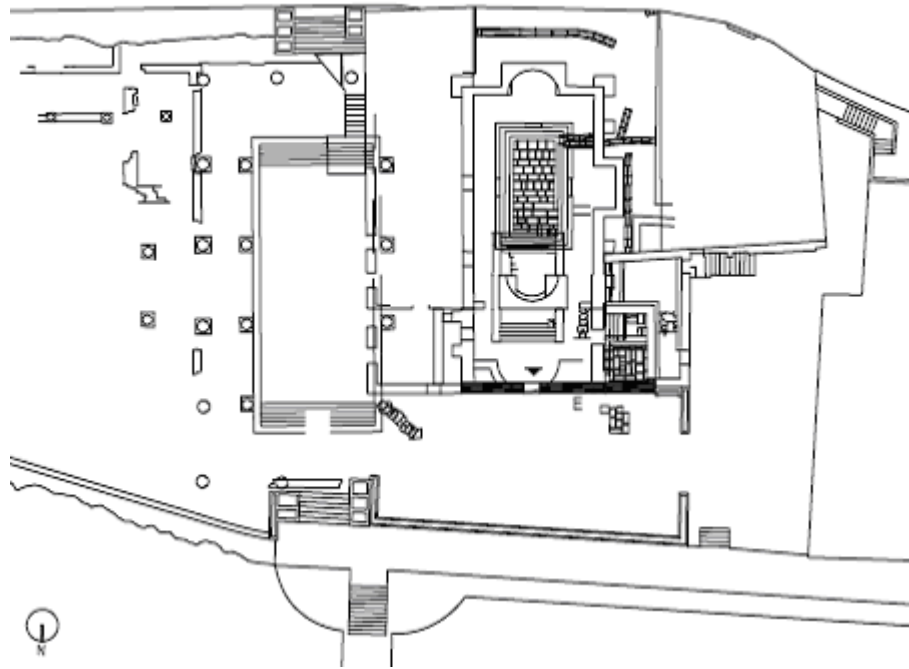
Planta e interior da parede E, a norte (Frade, 2000).
